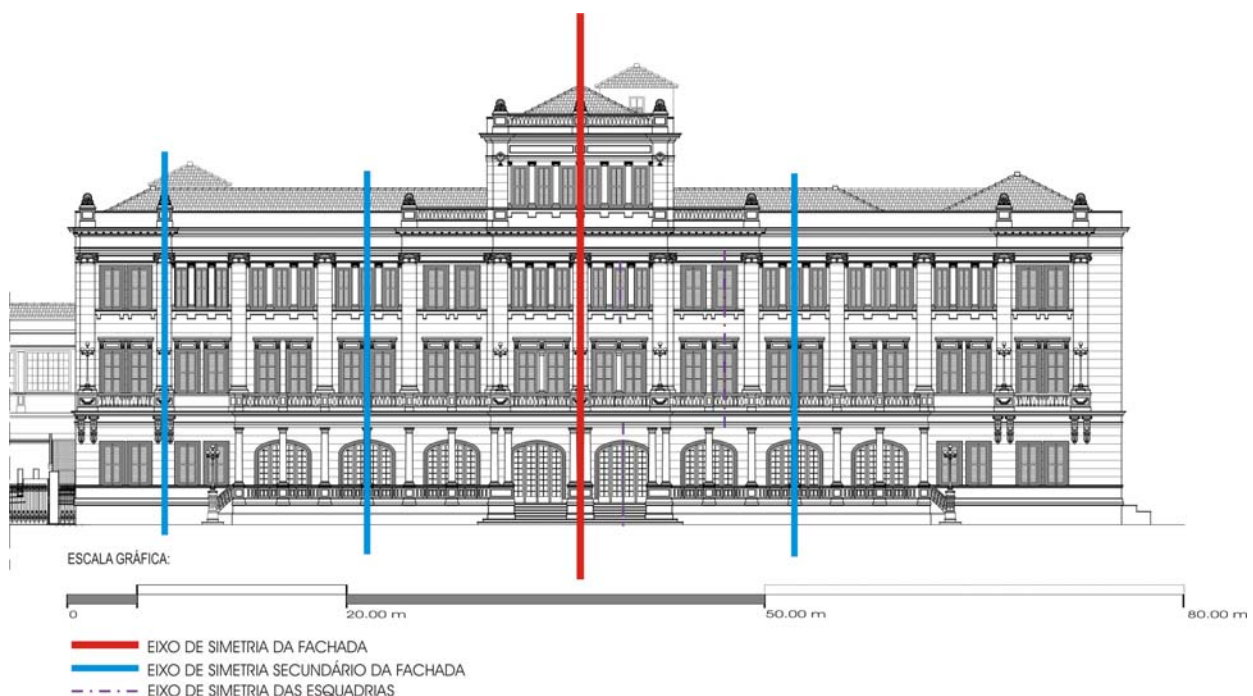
Desenho da Fachada Principal – eixos de simetria.
